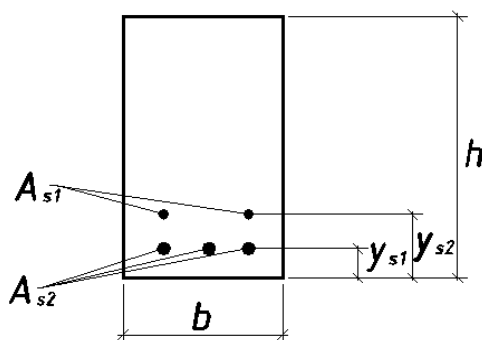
Сечение изгибаемого железобетонного элемента
